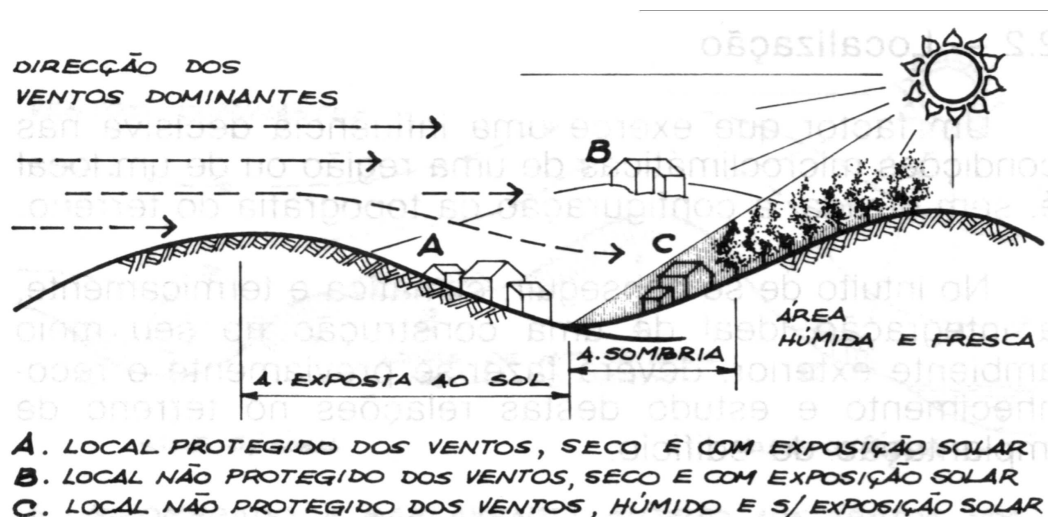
Pormenores de escolha do melhor local para construir. [6]
